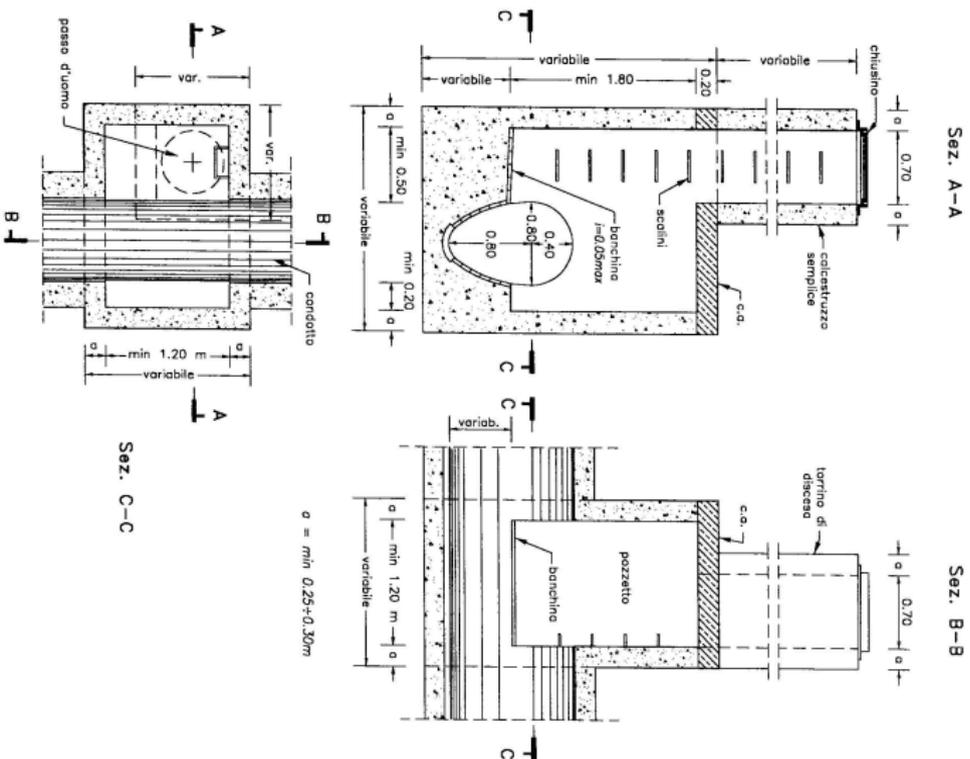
Pozzetto in cls per condotti a sezione ovoidale.
